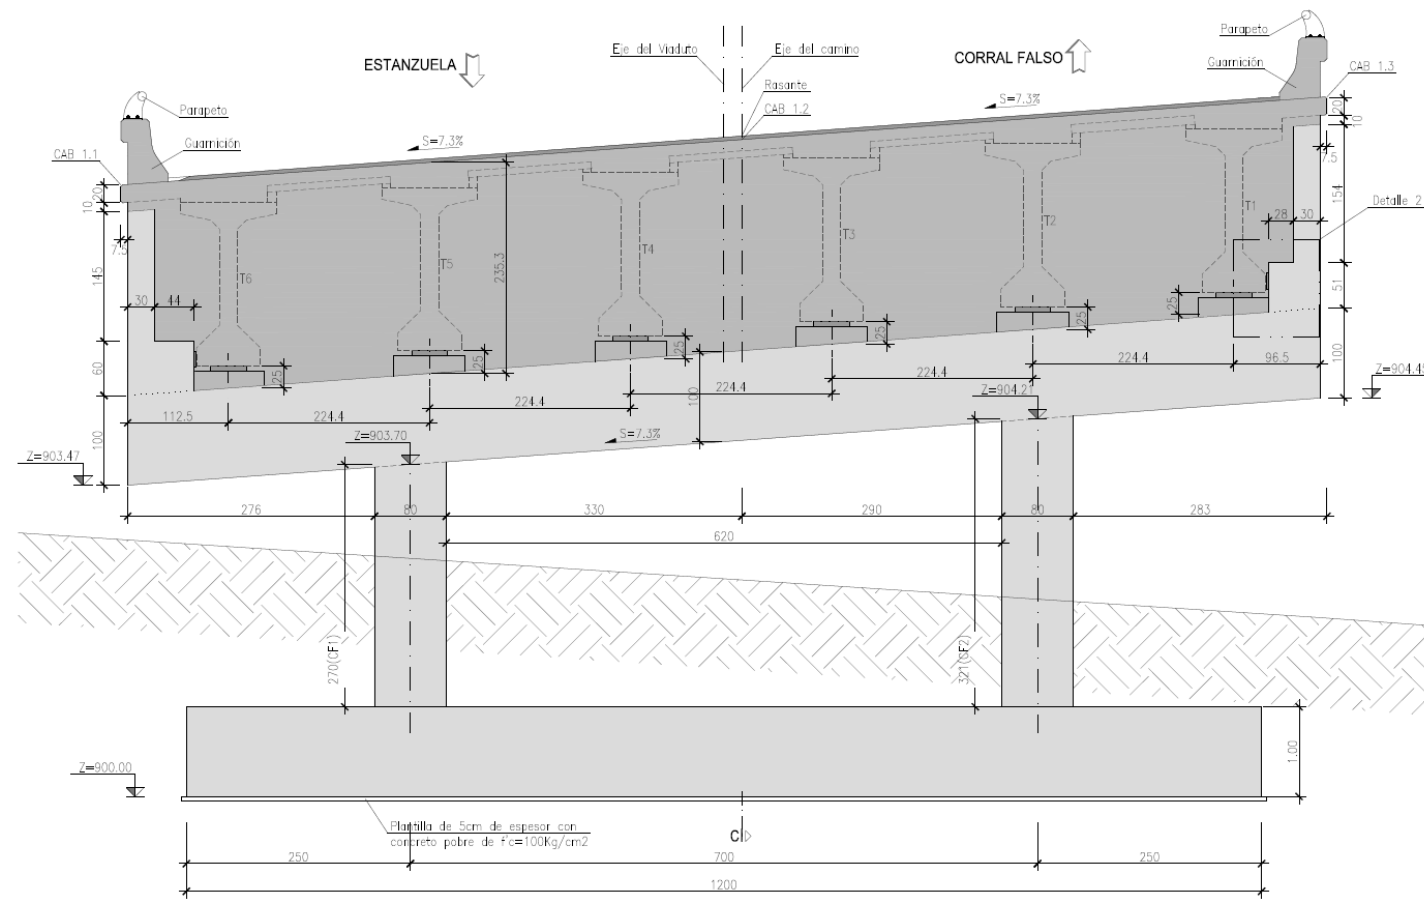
Alçado Frontal de um Encontro da Ponte.
